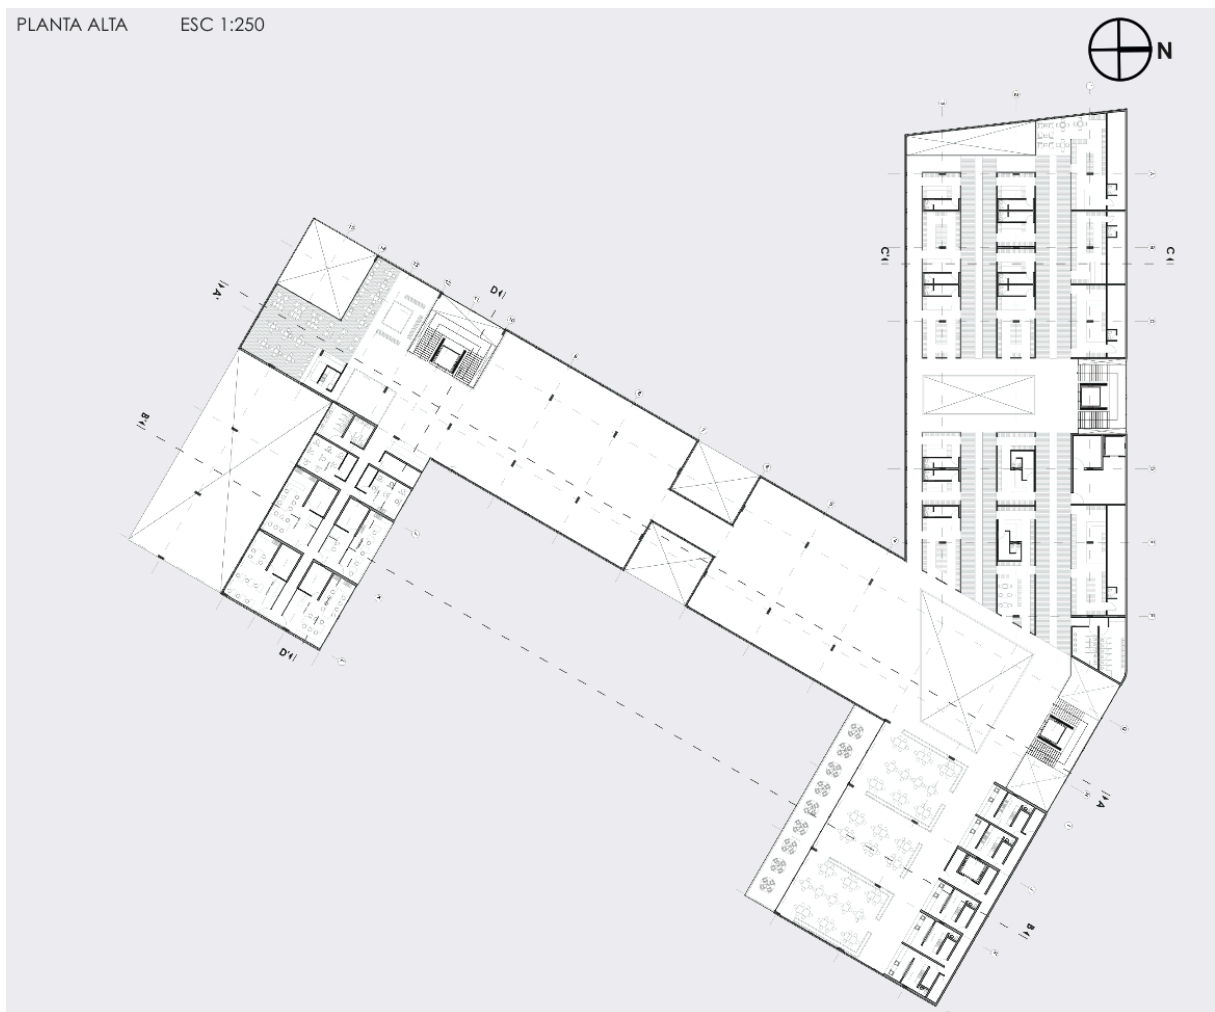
PLANTA ALTA (Elaboración Propia)
